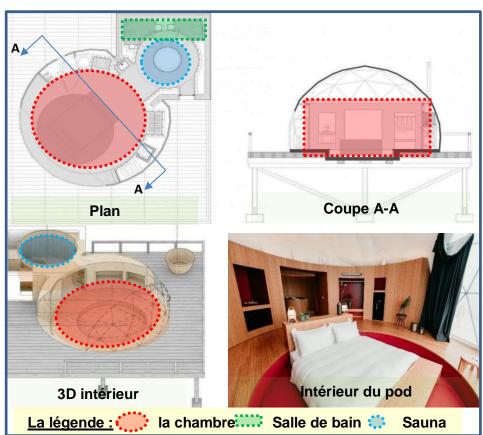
plan, coupe, 3D et intérieur du 007pod suite. Source : pinterest
